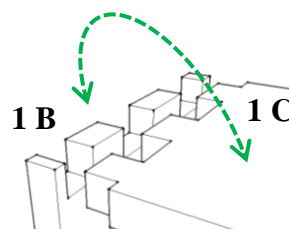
Exemplo de pormenor de uma hipótese da ligação dos painéis que constituem a estrutura da fábrica
